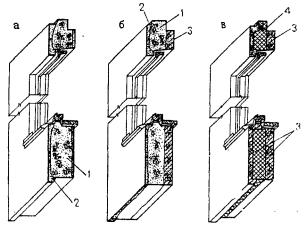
Бетонные панели наружных стен a — Однослойная; δ — двухслойная; s — трехслойная; t — конструктивно-теплоизоляционный бетон; t — защитно-отделочный слой; t — конструктивный бетон; t — эффективный угеплитель
